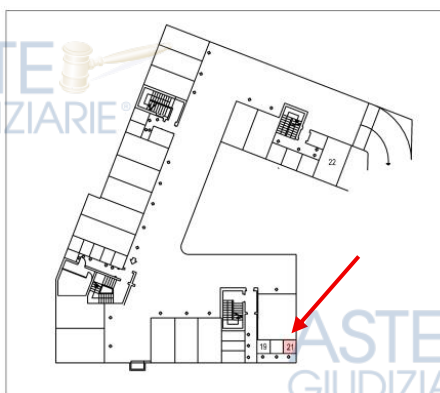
Individuazione della collocazione della cantina del subalterno 21 sulla planimetria del piano interrato
